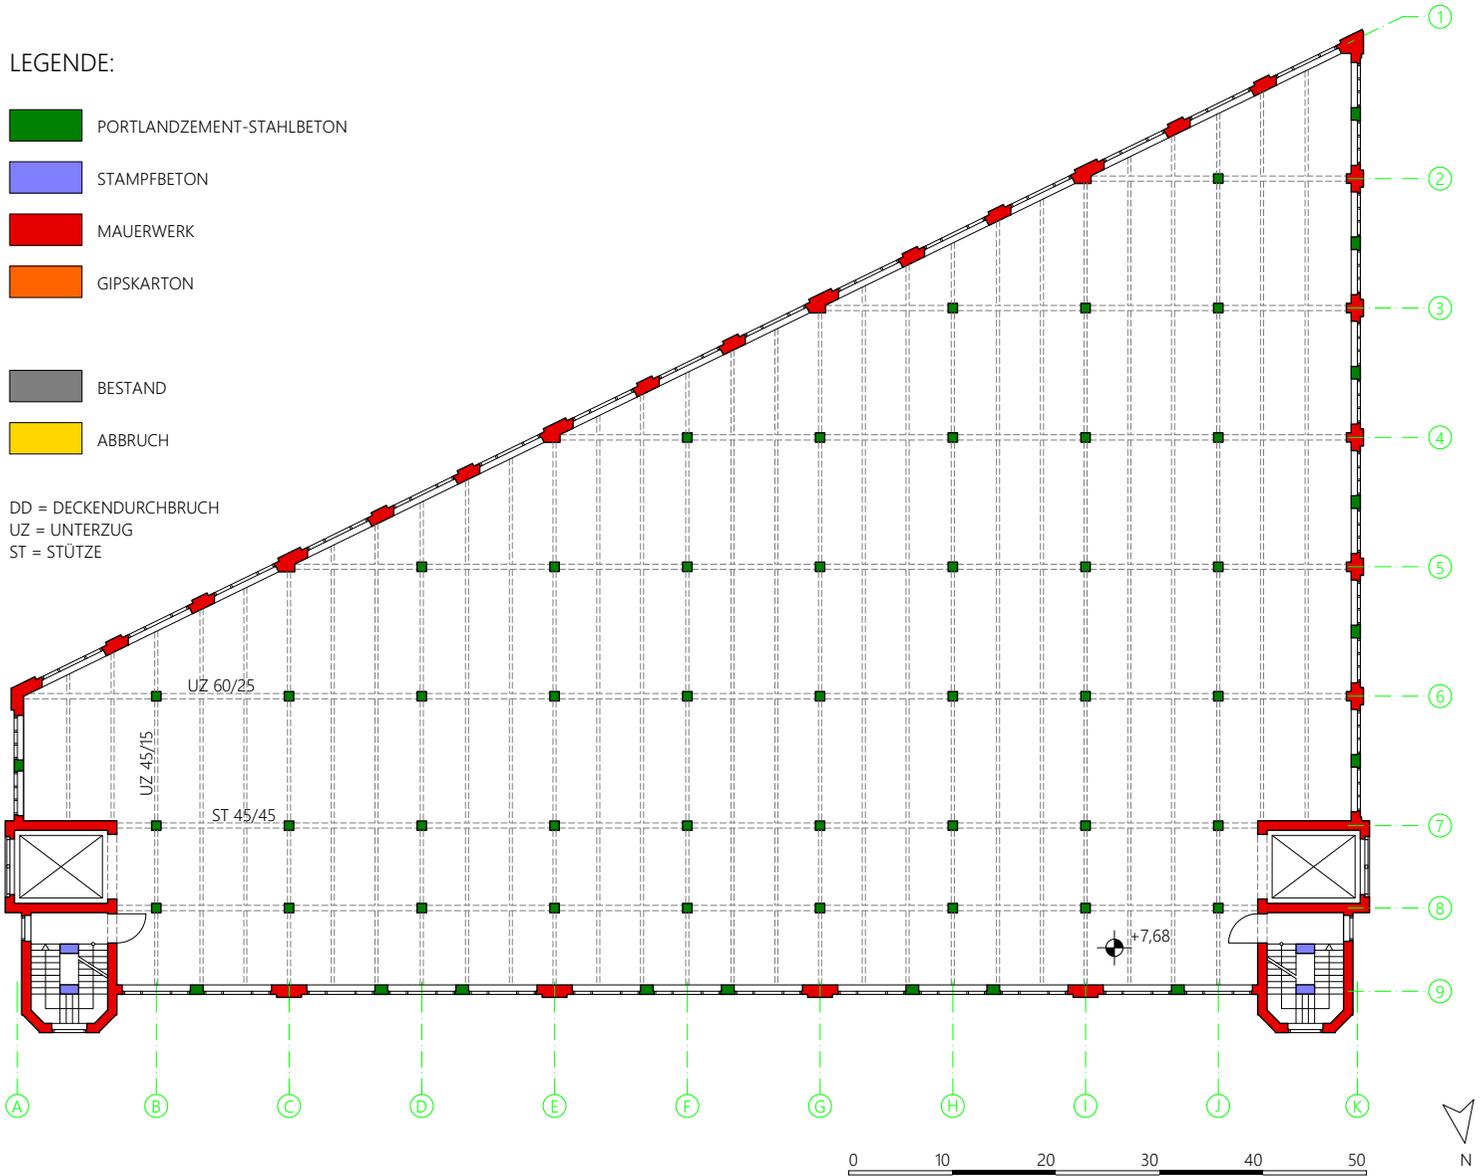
Bauphasenplan 1913: Zweites Obergeschoß des Maschinenmagazins
